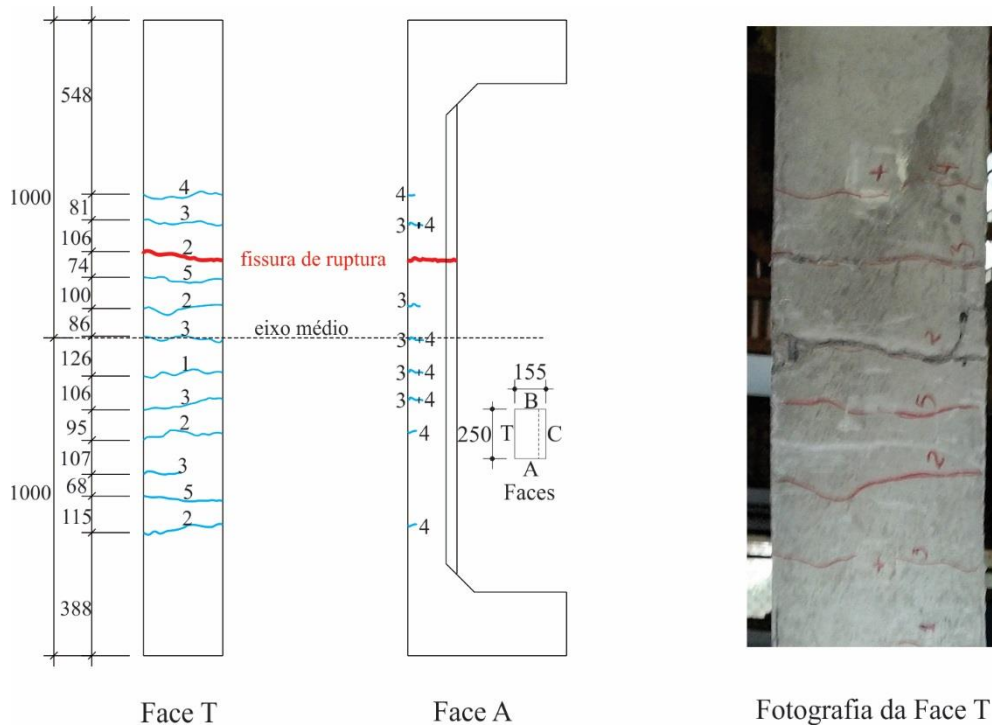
52 - Fissuras nas Faces T e A; Fotografia da face T- pilar AF-150-26
